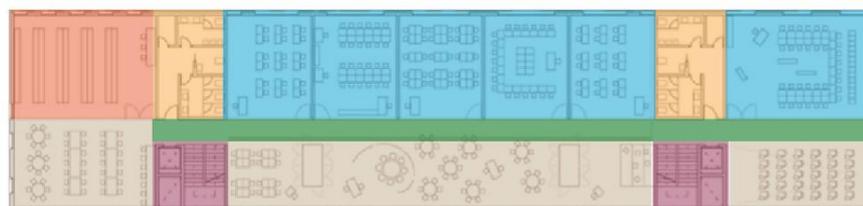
Colegio San Silvestre. Zonificación del pabellón de primaria. Planta Baja
